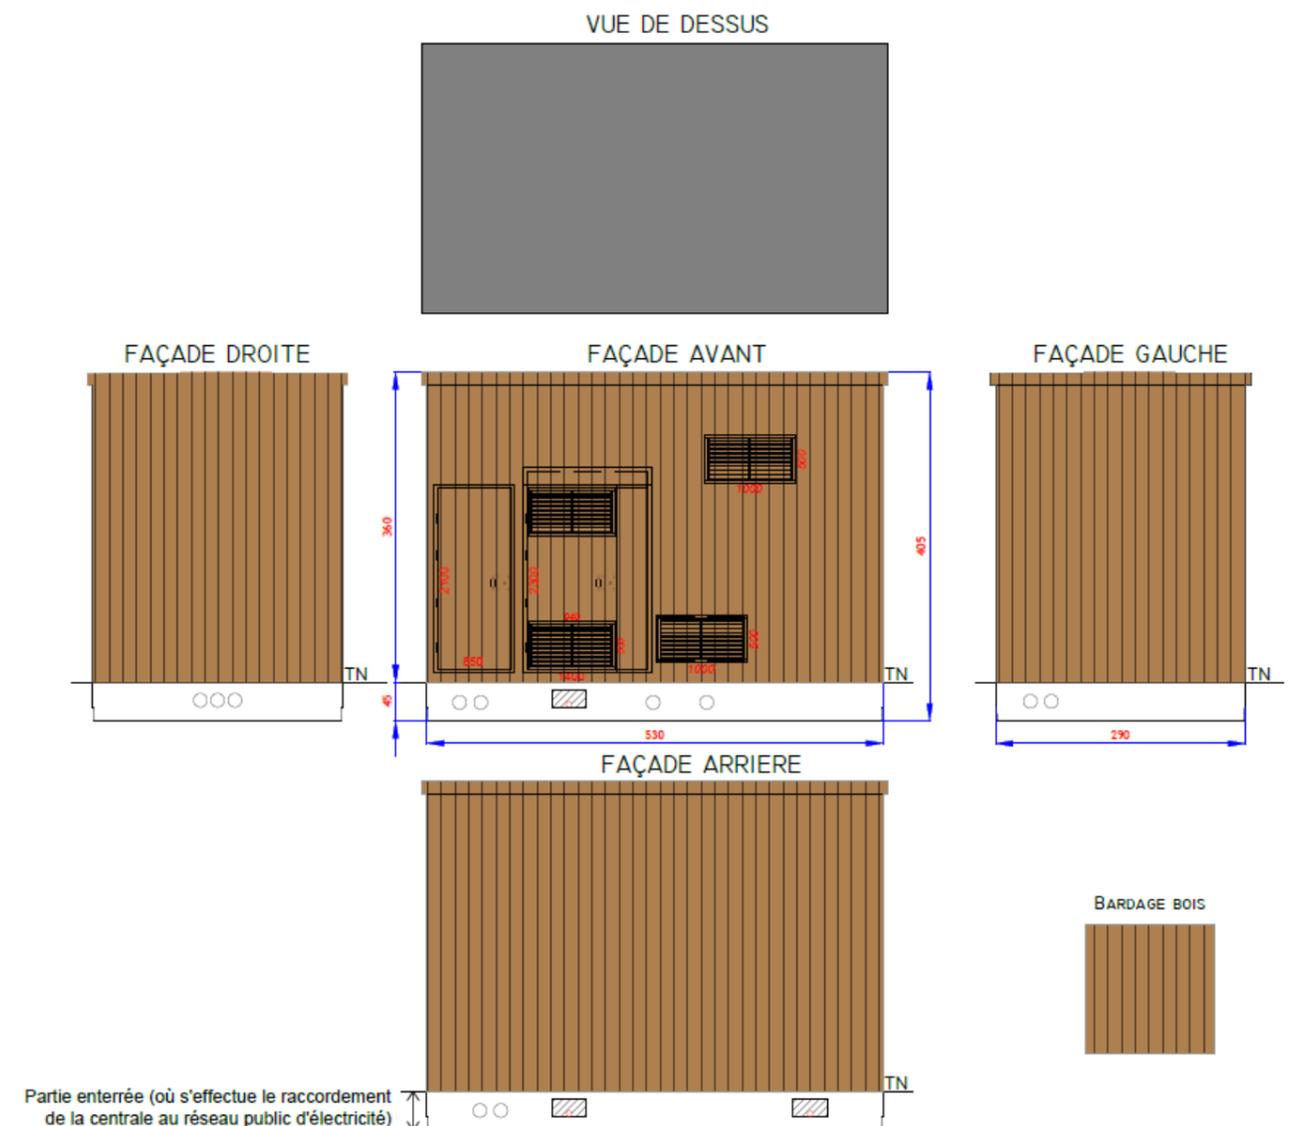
Vues des façades et en plan d'un poste de transformation prévu sur site (source : Terre et Lac Solaire)
